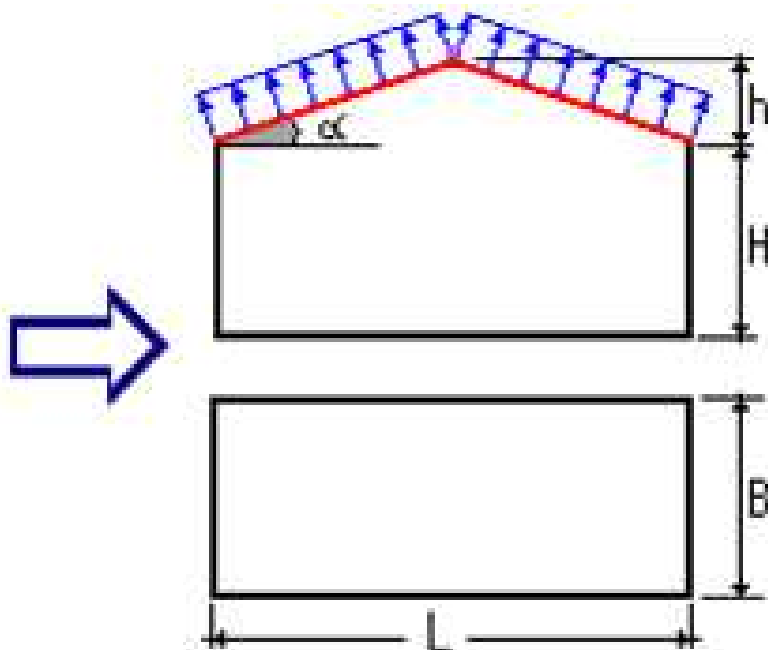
Схема приложения нагрузки на кровлю по оси Y
